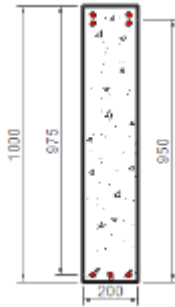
Seção Transversal da viga V5 – dimensões em milímetros (mm) – adaptado de Rogowsky *et al.* (1983).
